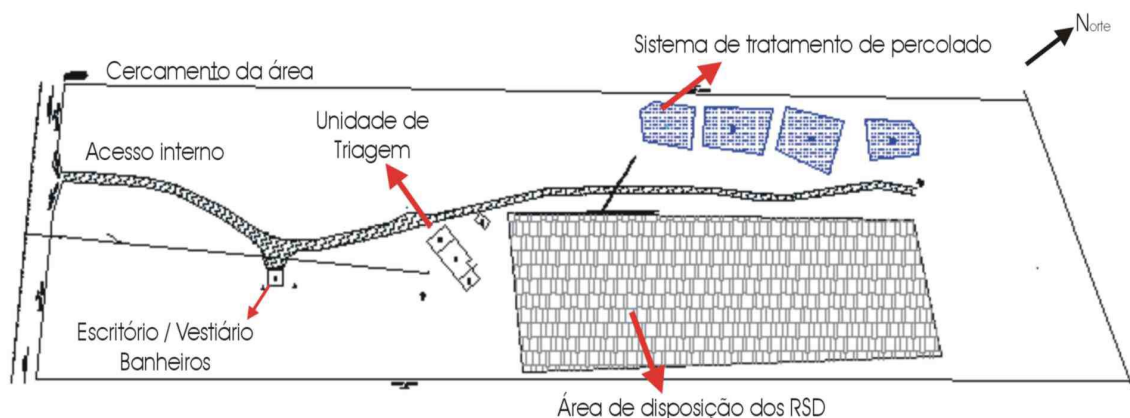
Esquema da planta baixa da atual situação da disposição final dos RSD ou Lixão.
